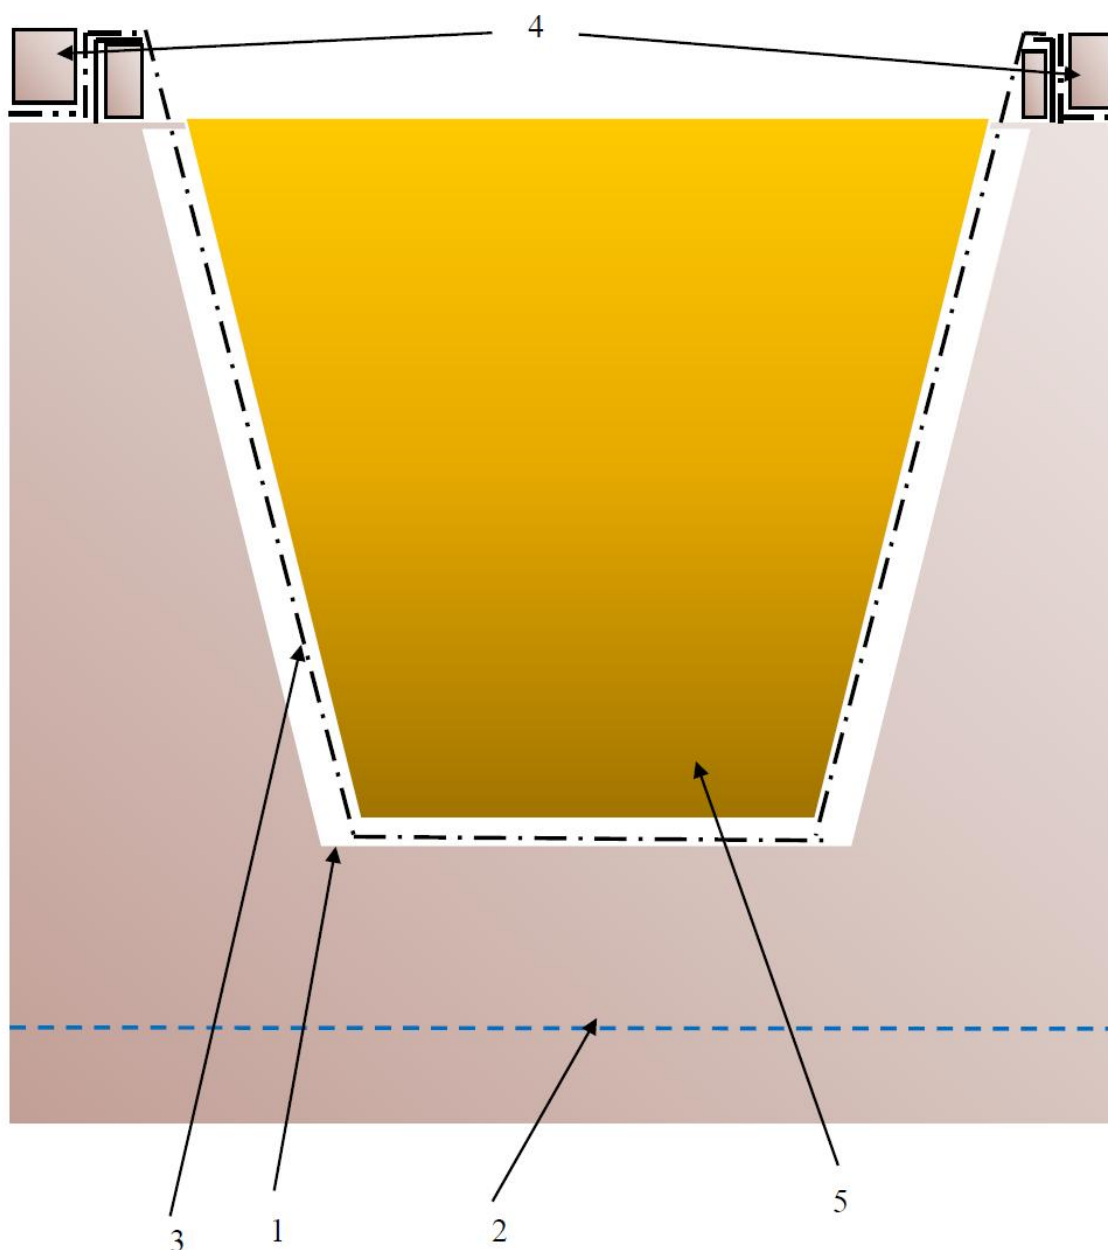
Схема конструкции открытой пленочной лагуны для хранения животноводческих стоков, где: 1 – выемка в грунте; 2 – уровень грунтовых вод; 3 – пленочная гидроизоляция; 4 – земляной замок; 5 – животноводческие стоки.
